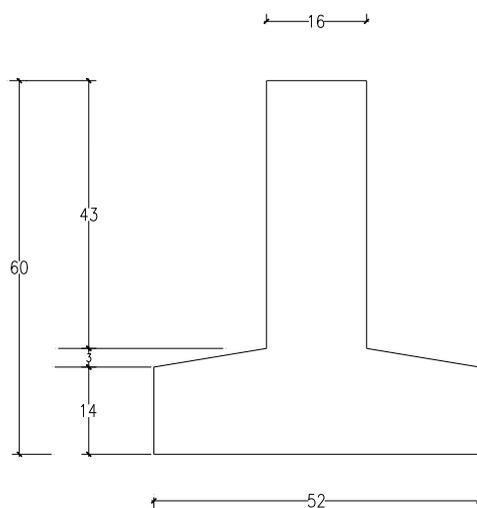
DETALLES DE VIGAS PROPUESTA EN LA RECONSTRUCCIÓN DEL PUENTE 17 DE SEPTIEMBRE.
